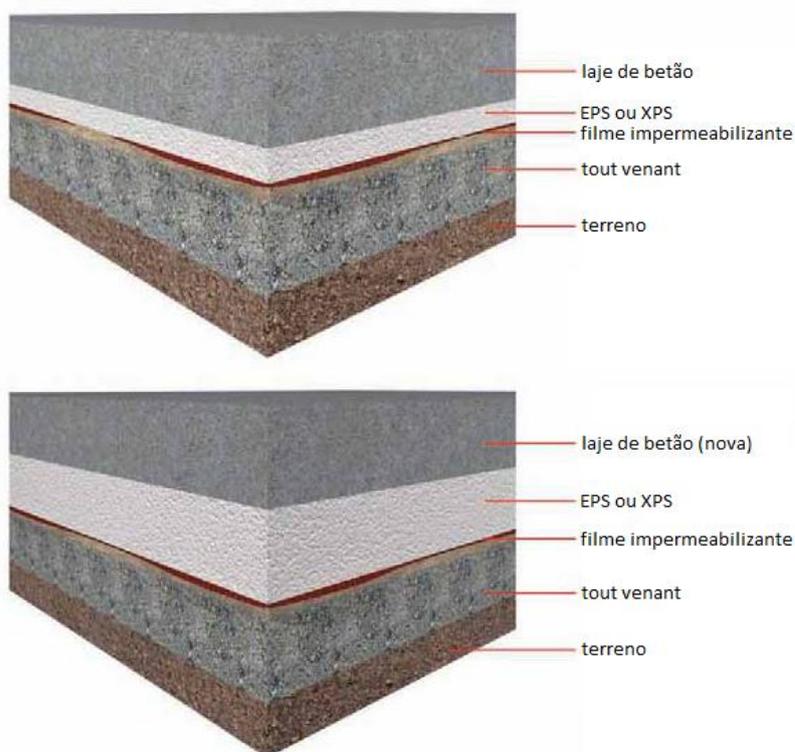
Exemplo de solução construtiva de pavimento térreo, existente e reabilitada
